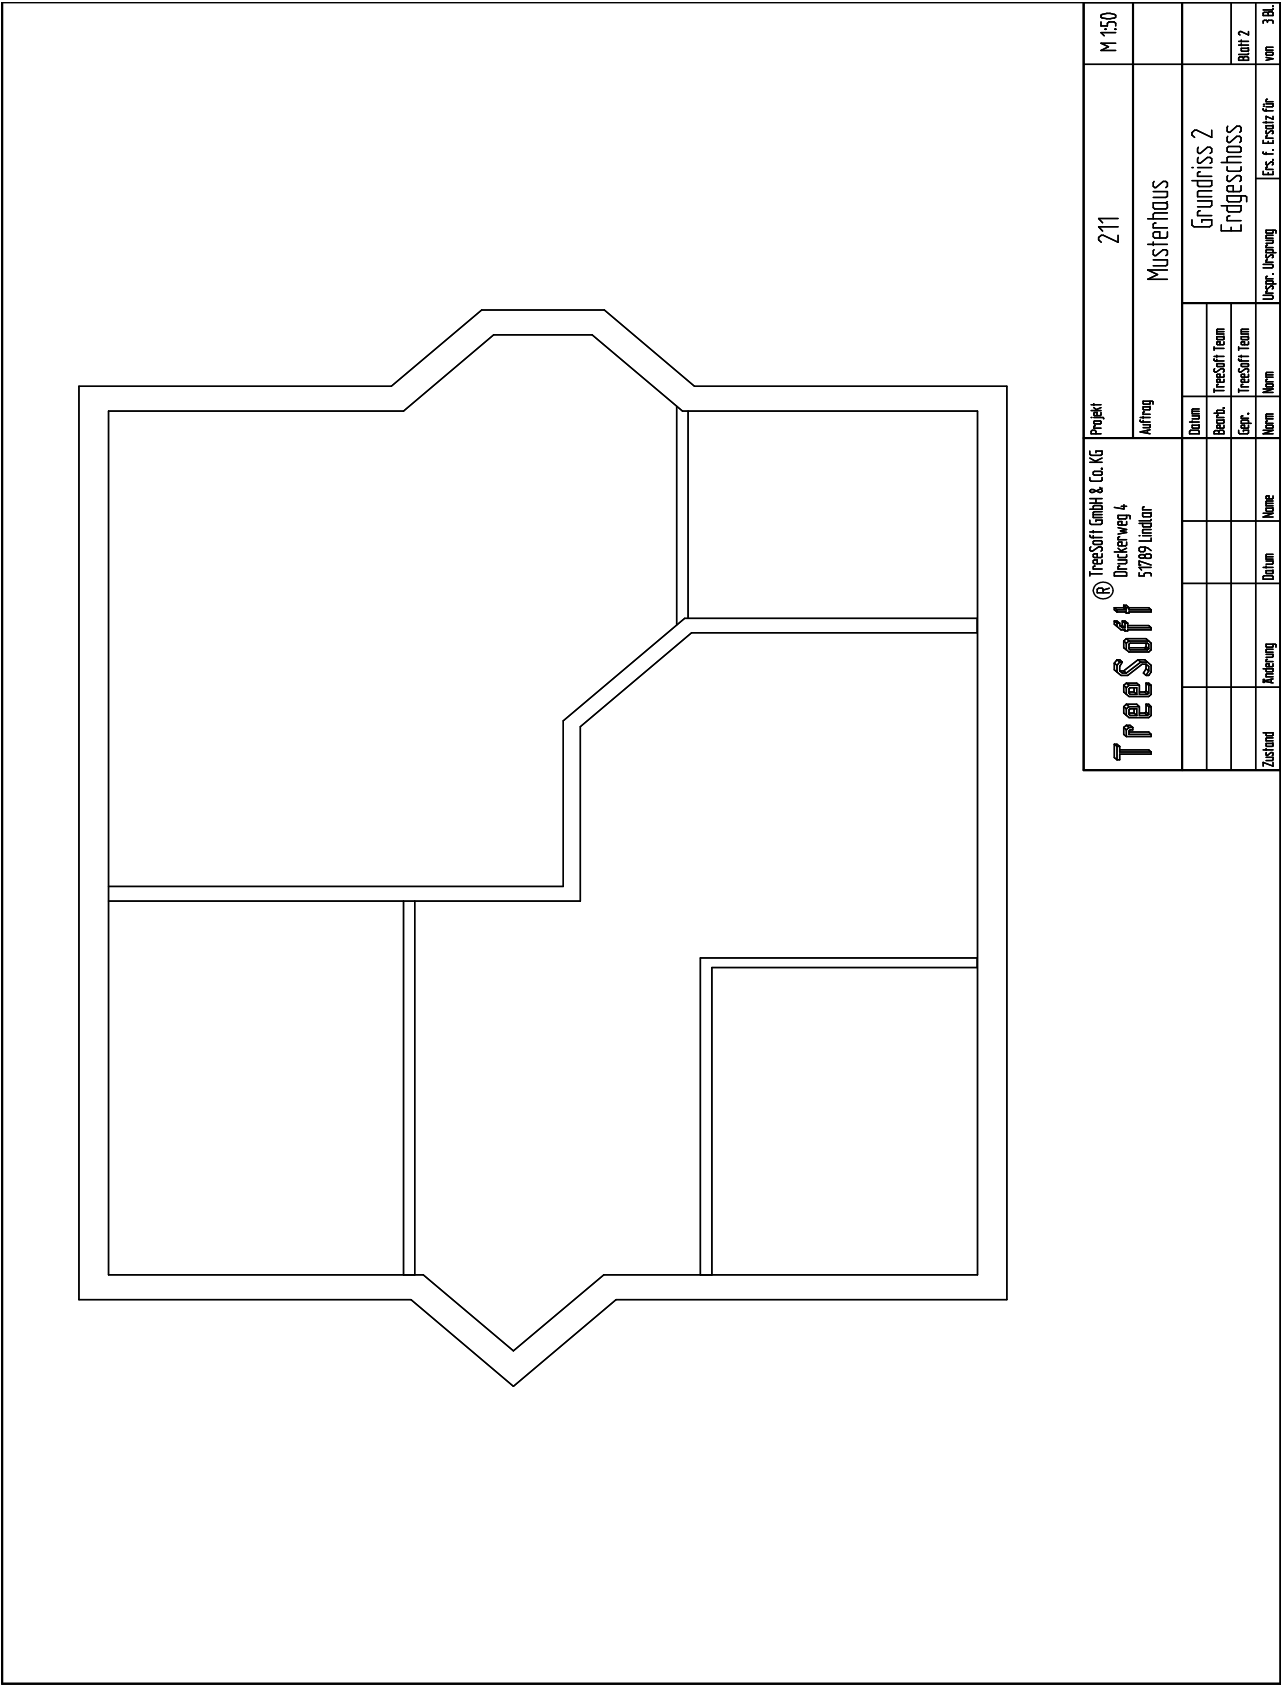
Grundriss mit Innenwänden
